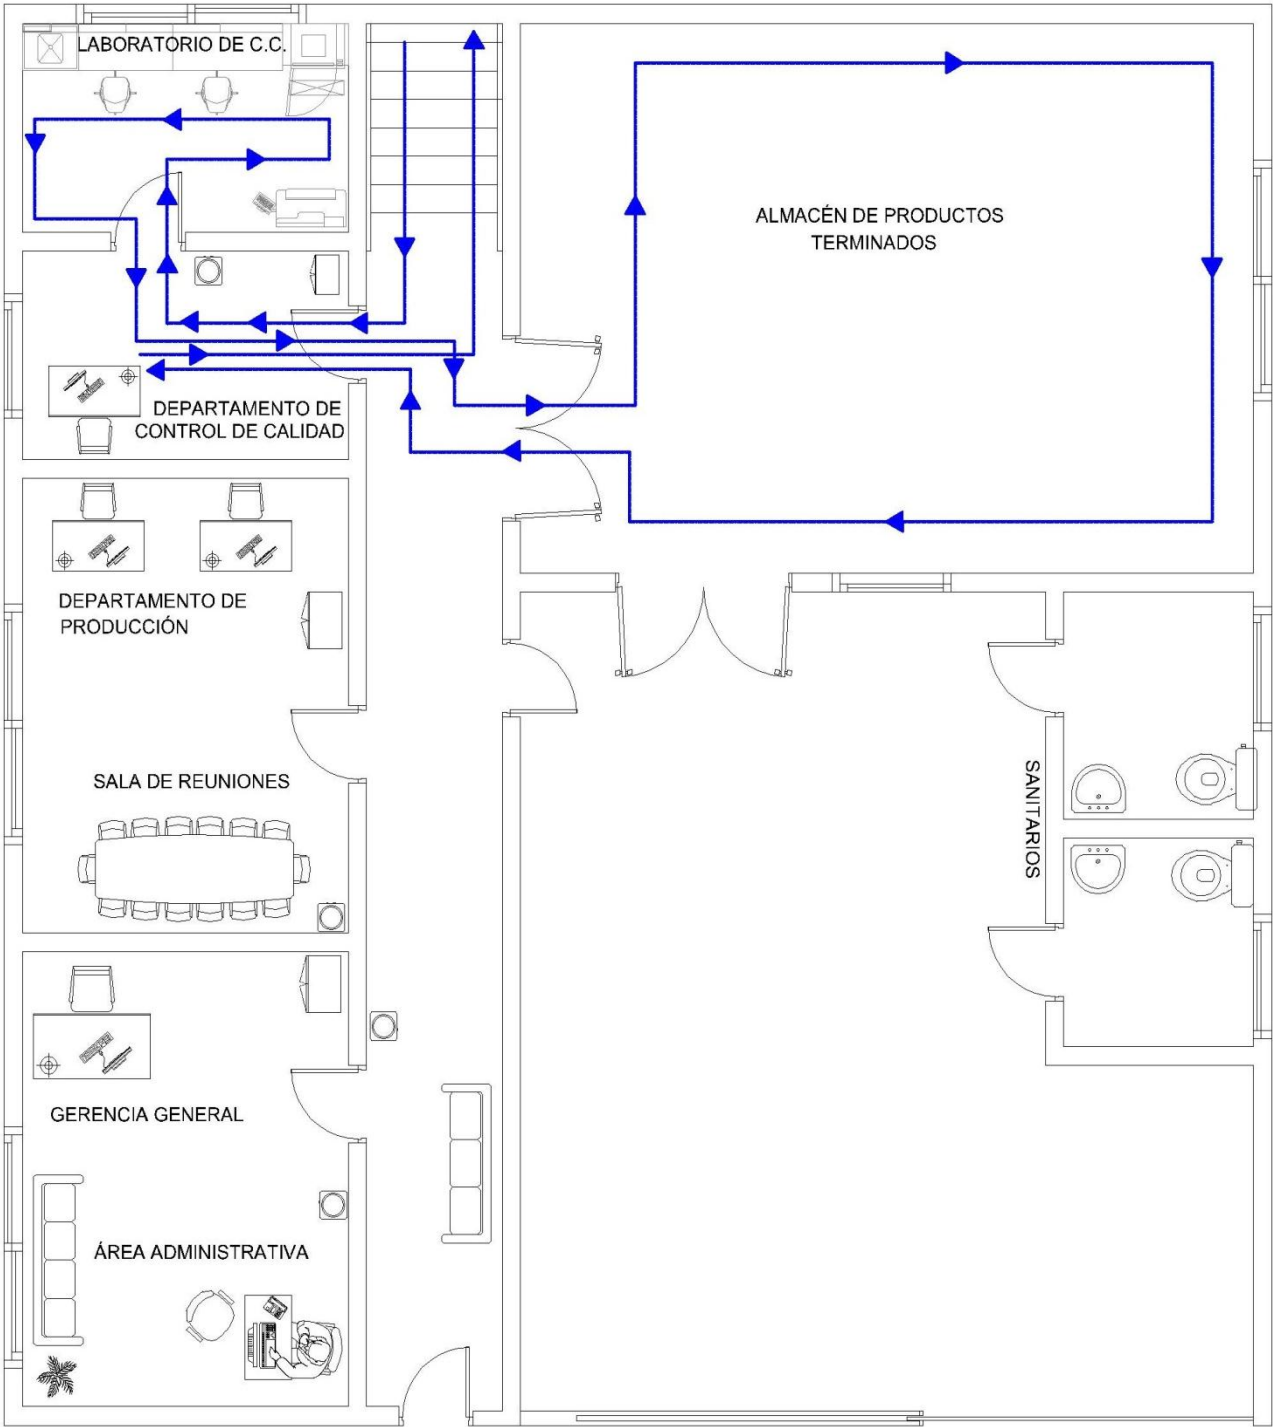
Plano: Recorrido en planta baja del jefe de departamento de control de calidad. Fuente: Rondón (2018)
